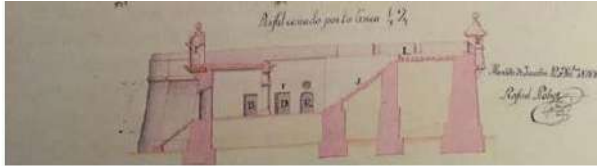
Plano Llobet. 1788 fuerte de sisal. fuente: Antonchiw
